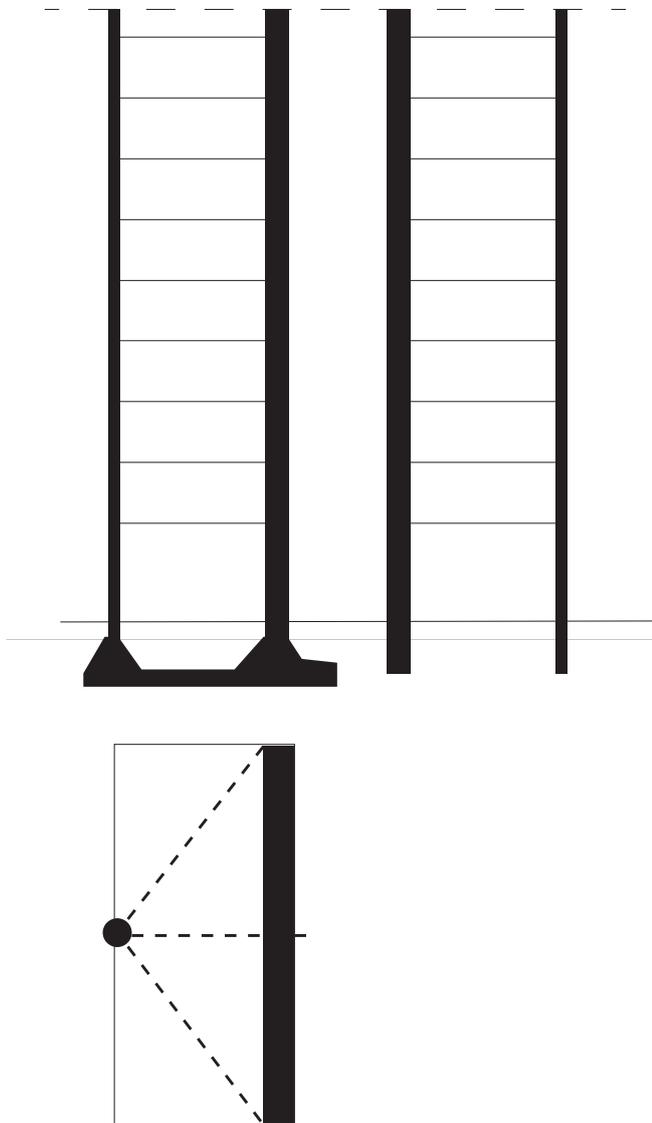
Teca tecnica autoportante, rapporto tra setto murario e pilastro in c.a. Schema geometrica. Schema assonometrico
